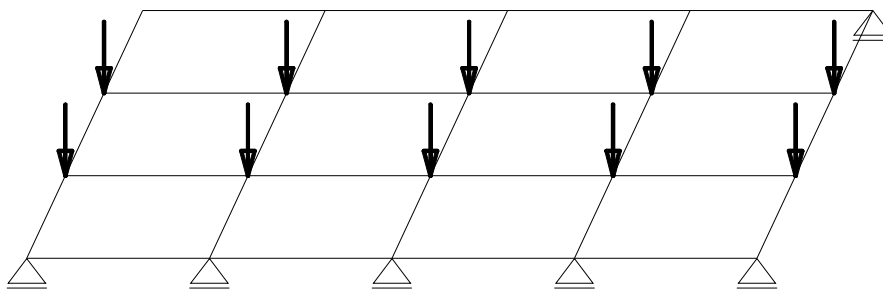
Grelha plana (Fonte: PFEIL, 2000, p.26)
